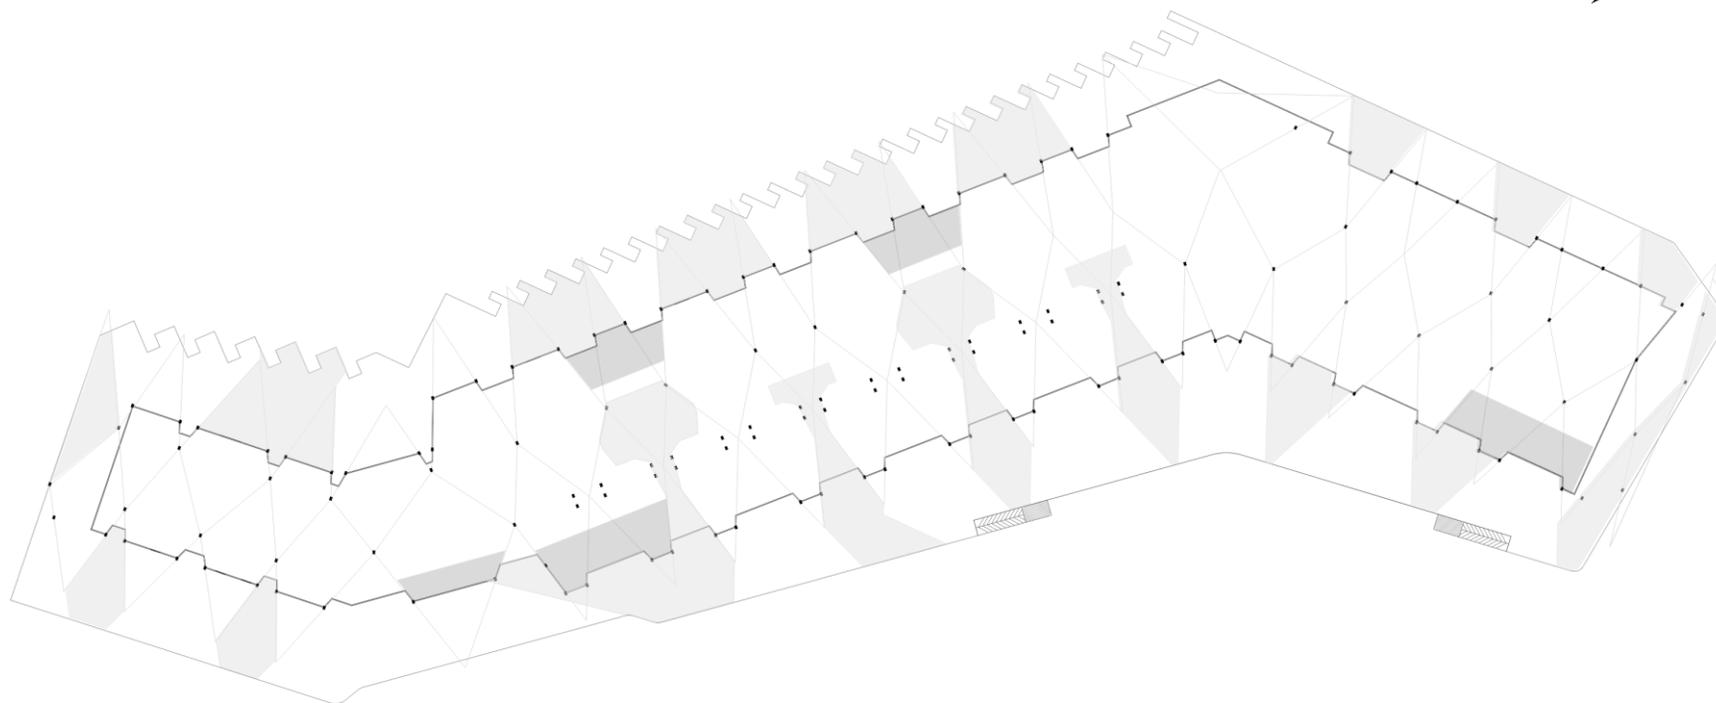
Espacios tomados de la proyección de la cubierta del proyecto
